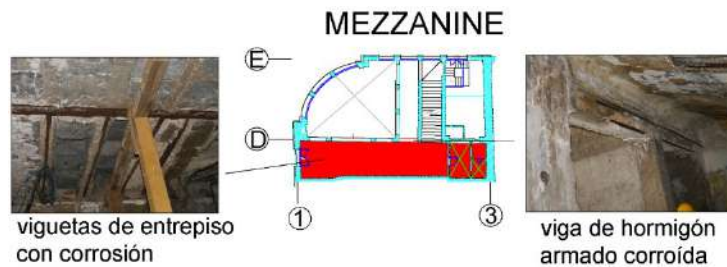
Estructura del mezzanine compuesta por losa hollow tile apoyada sobre viga de hormigón armado, severamente afectada por fenómenos de corrosión atmosférica.
